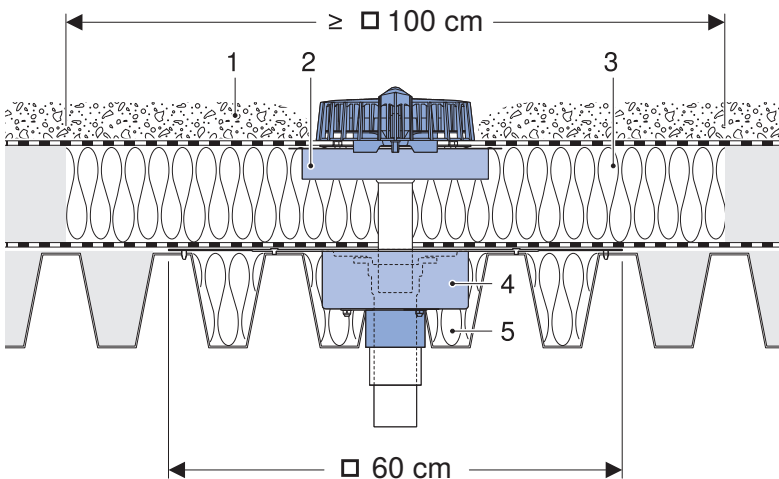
Dachaufbau Geberit Pluvia Dachdurchführung mit Brandschutz, gedämmte Dächer
